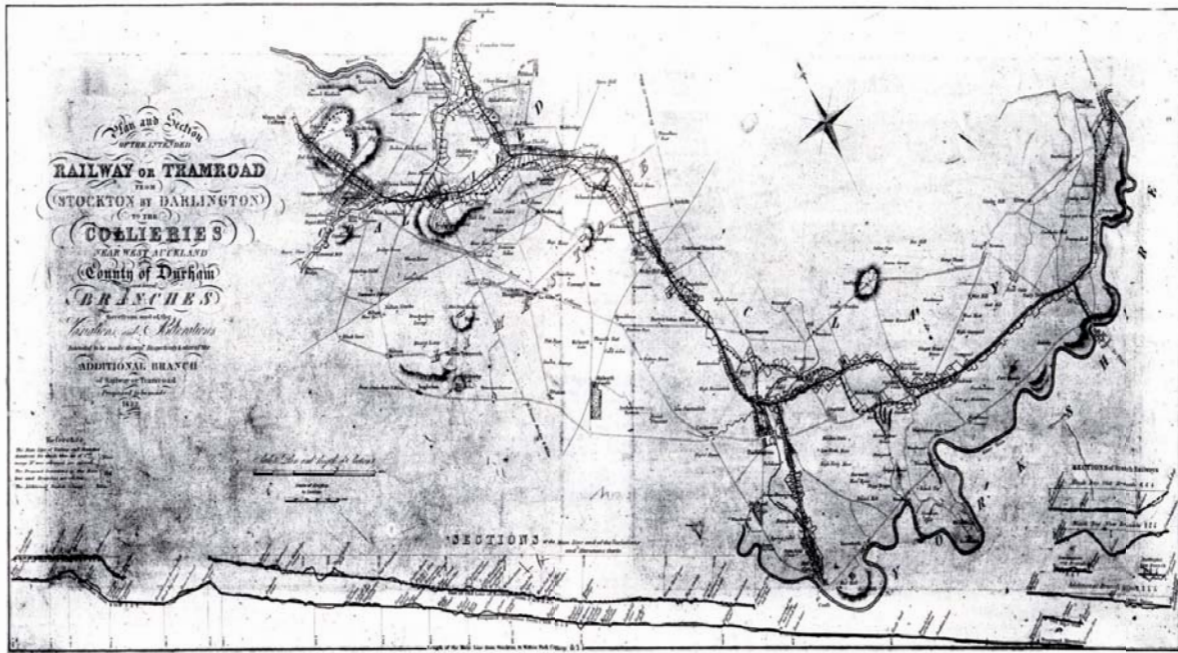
Planta y perfil longitudinal del ferrocarril de Stockton a Darlington (1822). (Science Museum, Londres).
